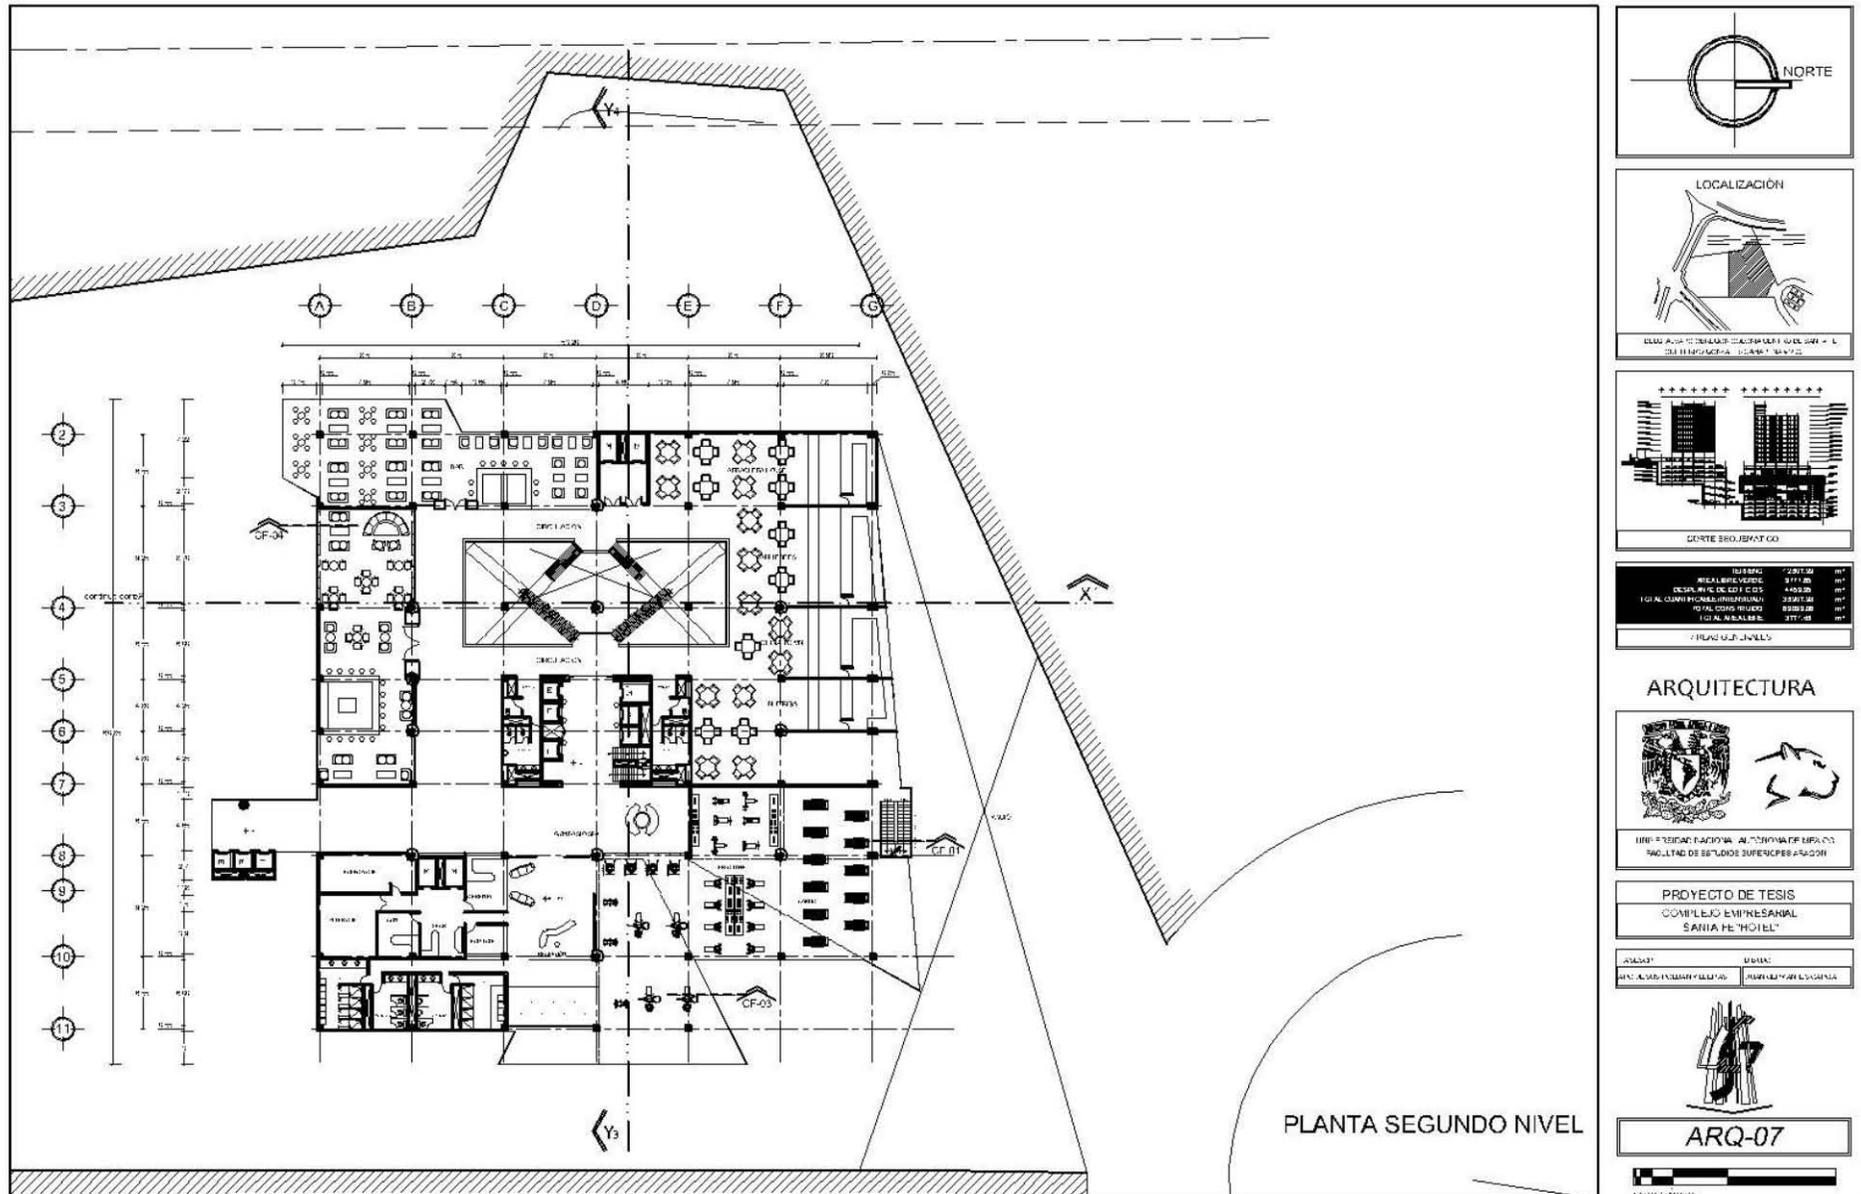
Plano ARQ-07; Planta Segundo Nivel Hotel/Centro Comercial. Edición propia.
